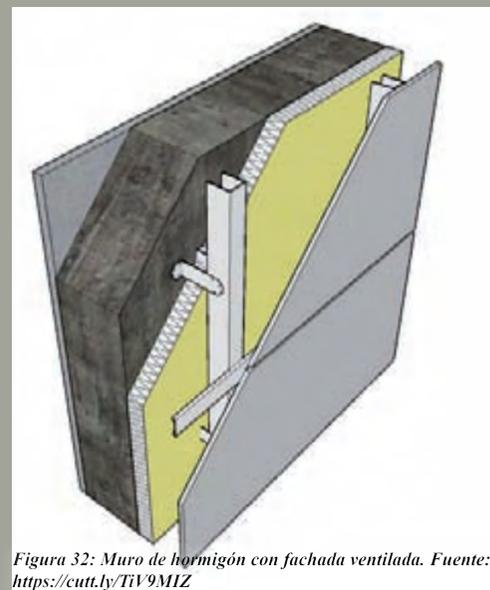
Muro de hormigón con fachada ventilada. Fuente: <https://cutt.ly/TIV9MIZ>
